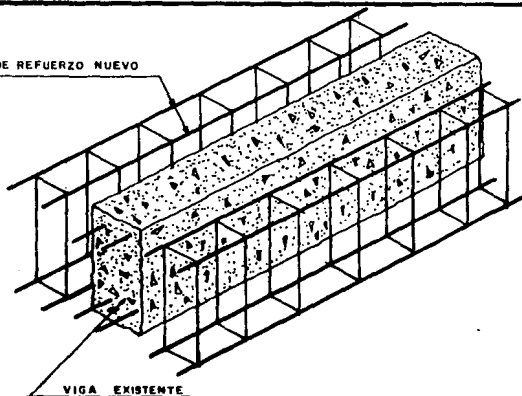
ENCAMISADO DE UNA VIGA DE CONCRETO
